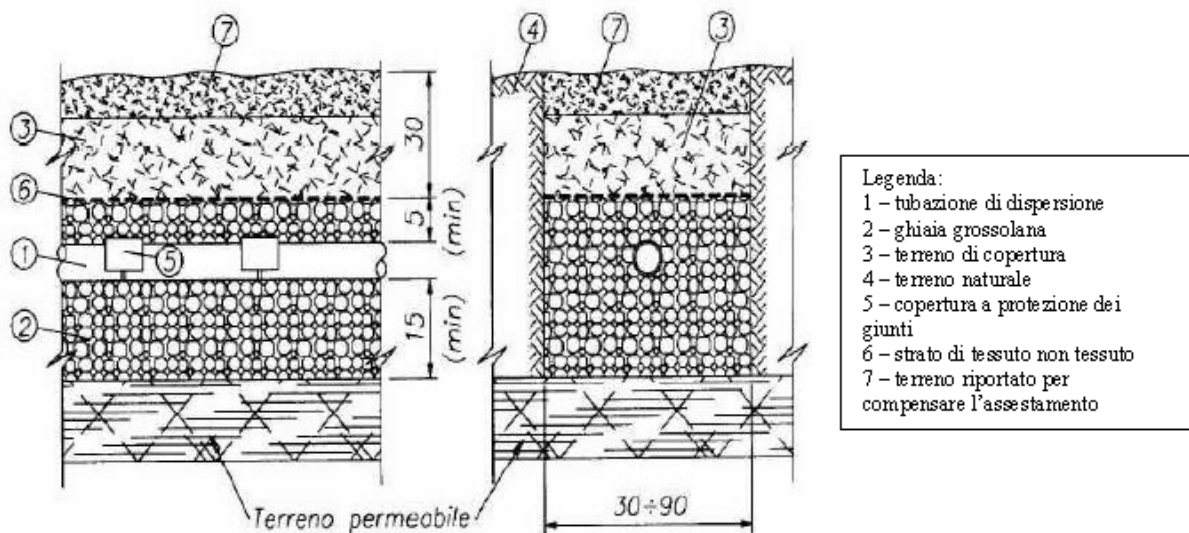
Schema di trincea per la sub-irrigazione nel terreno
